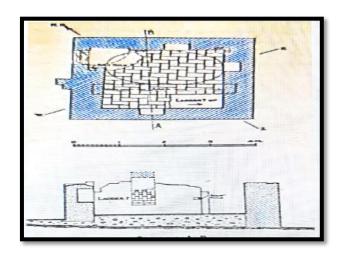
مسقط أفقى لدير أبيفانيوس
